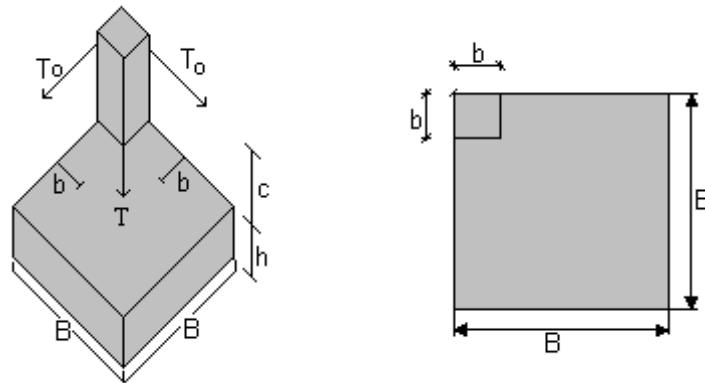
Geometría del Modelo Estructural de la Zapata Esquinera con Dos Vigas Aéreas Presentado por José Calavera.
